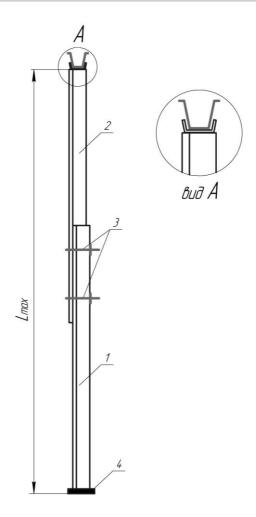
Вариант стойки усиления крепи подготовительной выработки: 1 — нижний отрезок профиля СВП с опорным башмаком (4); 2 — верхний отрезок профиля СВП с вариантами конструктивного исполнения контактной группы с верхняком крепи подготовительной выработки; 3 — замок крепления призабойной стойки к нижней стойке из профиля СВП типа АПЗ.030; 4 — опорный башмак нижней стойки
